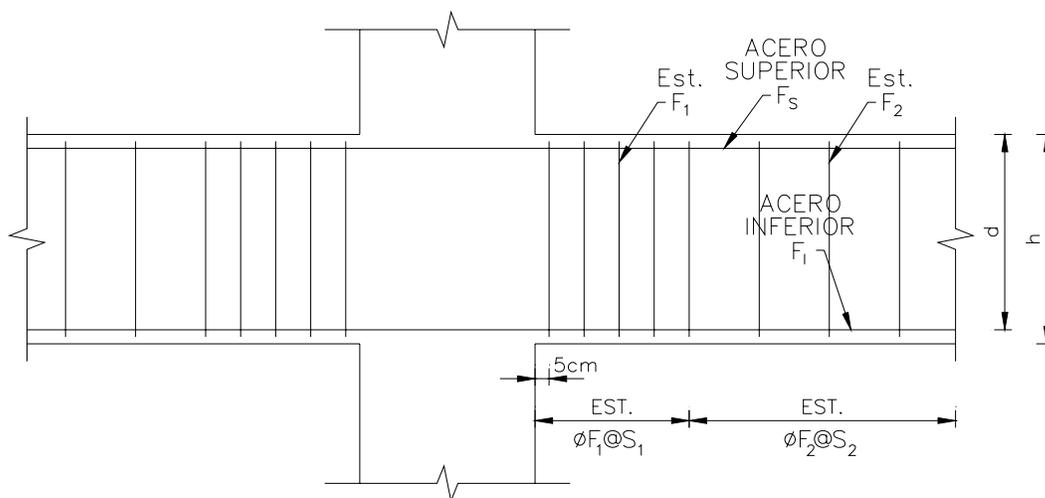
Nomenclatura de refuerzos transversales.
